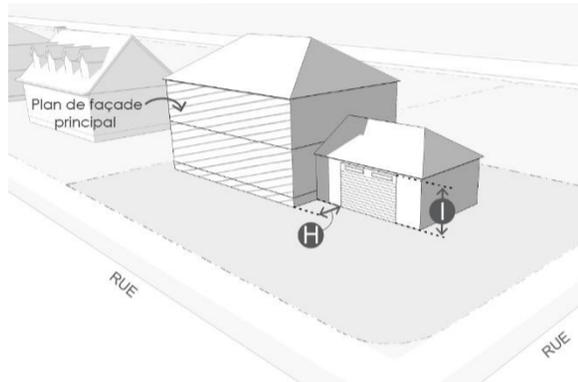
Retrait d'un garage par rapport à un plan de façade principal et hauteur d'une porte de garage
